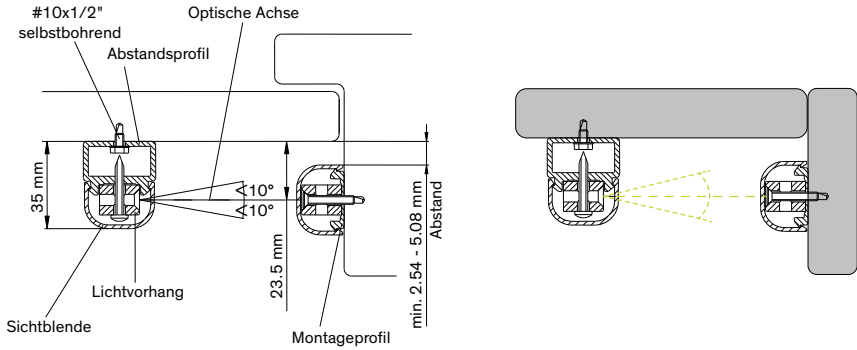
Montagetails von seitlich öffnenden Türen mit Abstands- und Montageprofil
